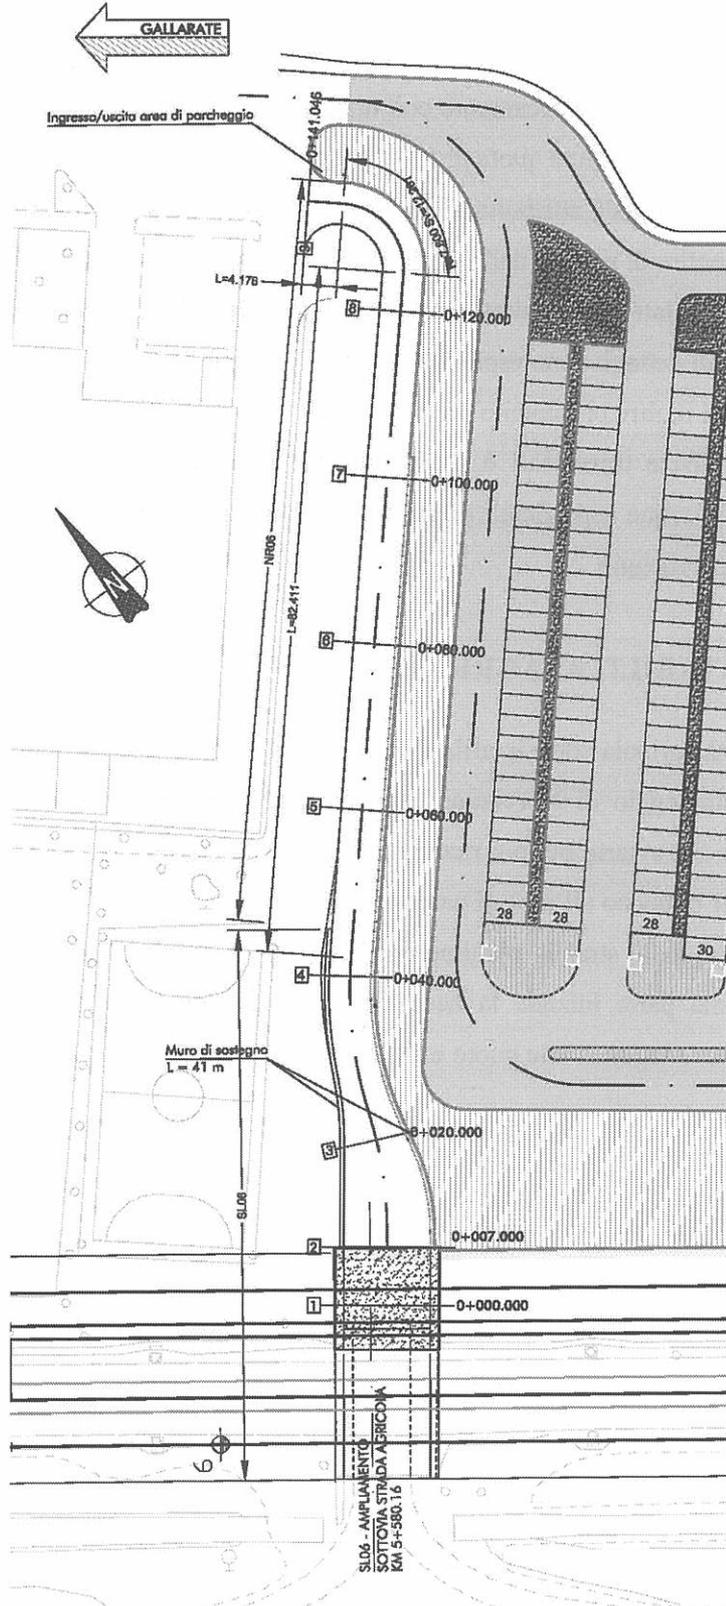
Stralcio planimetrico della nuova viabilità agricola
